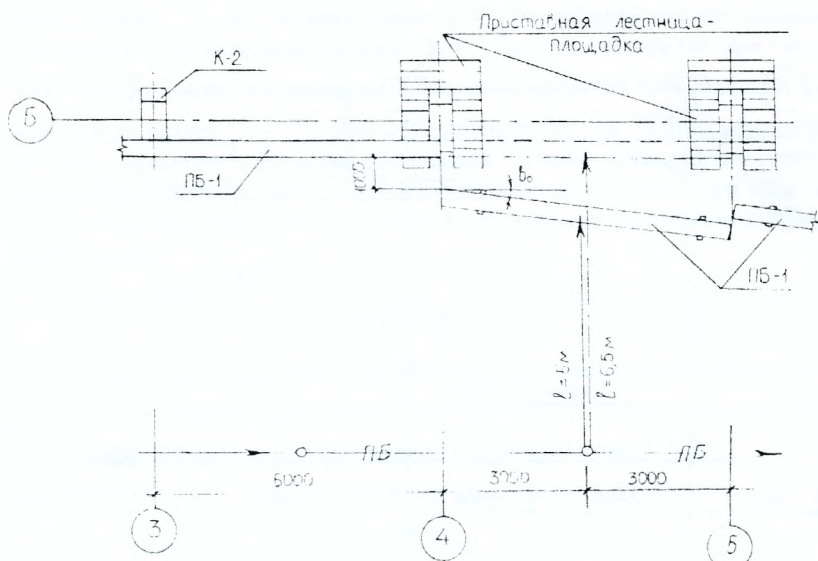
Схема монтажа подкрановых балок изменением вылета стрелы
